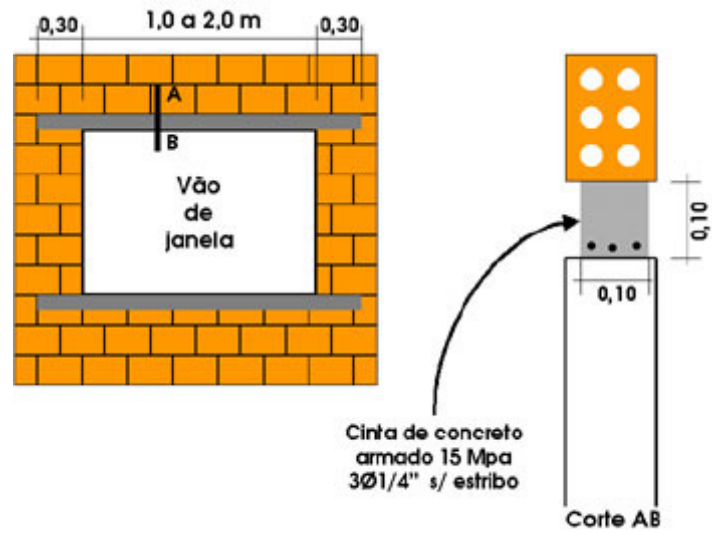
Detalhamento da utilização da verga/contraverga em janela
